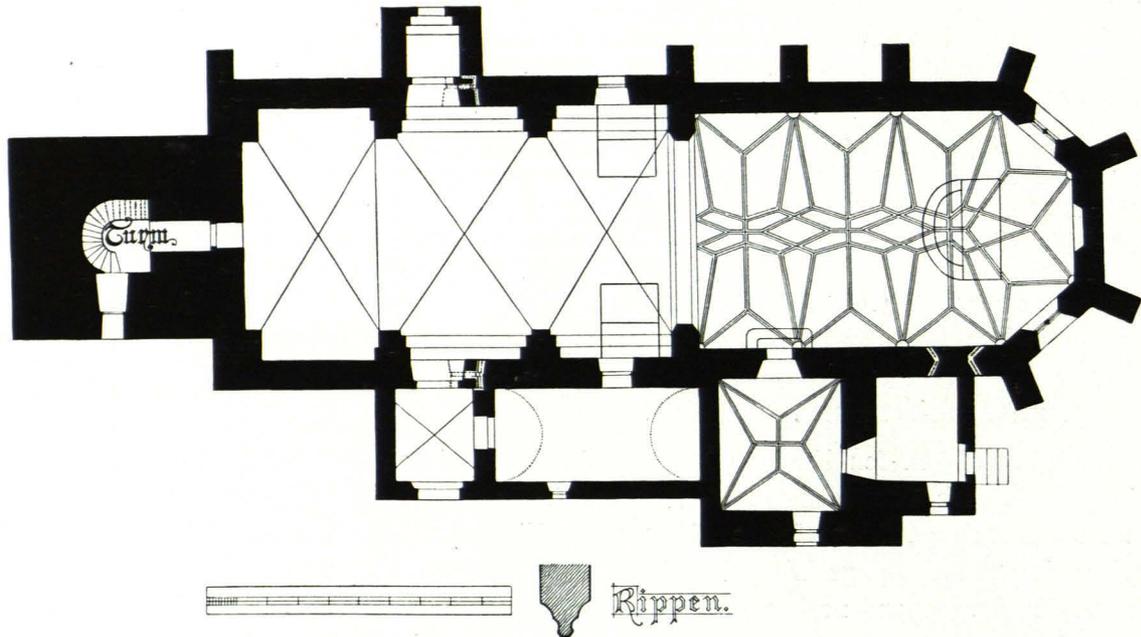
St. Oswald, Pfarrkirche, Grundriß 1:200 (S. 131)
